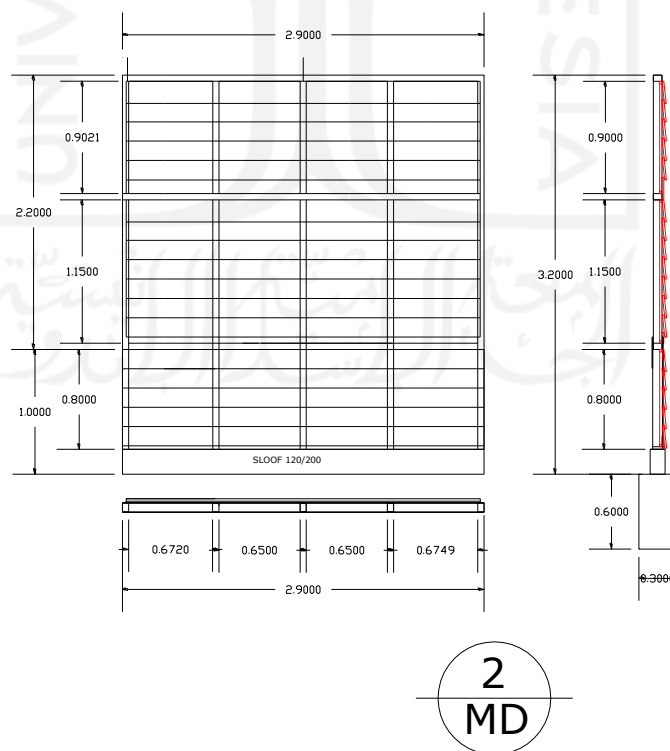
Denah Rencana Dinding Huntara Tipe 54
